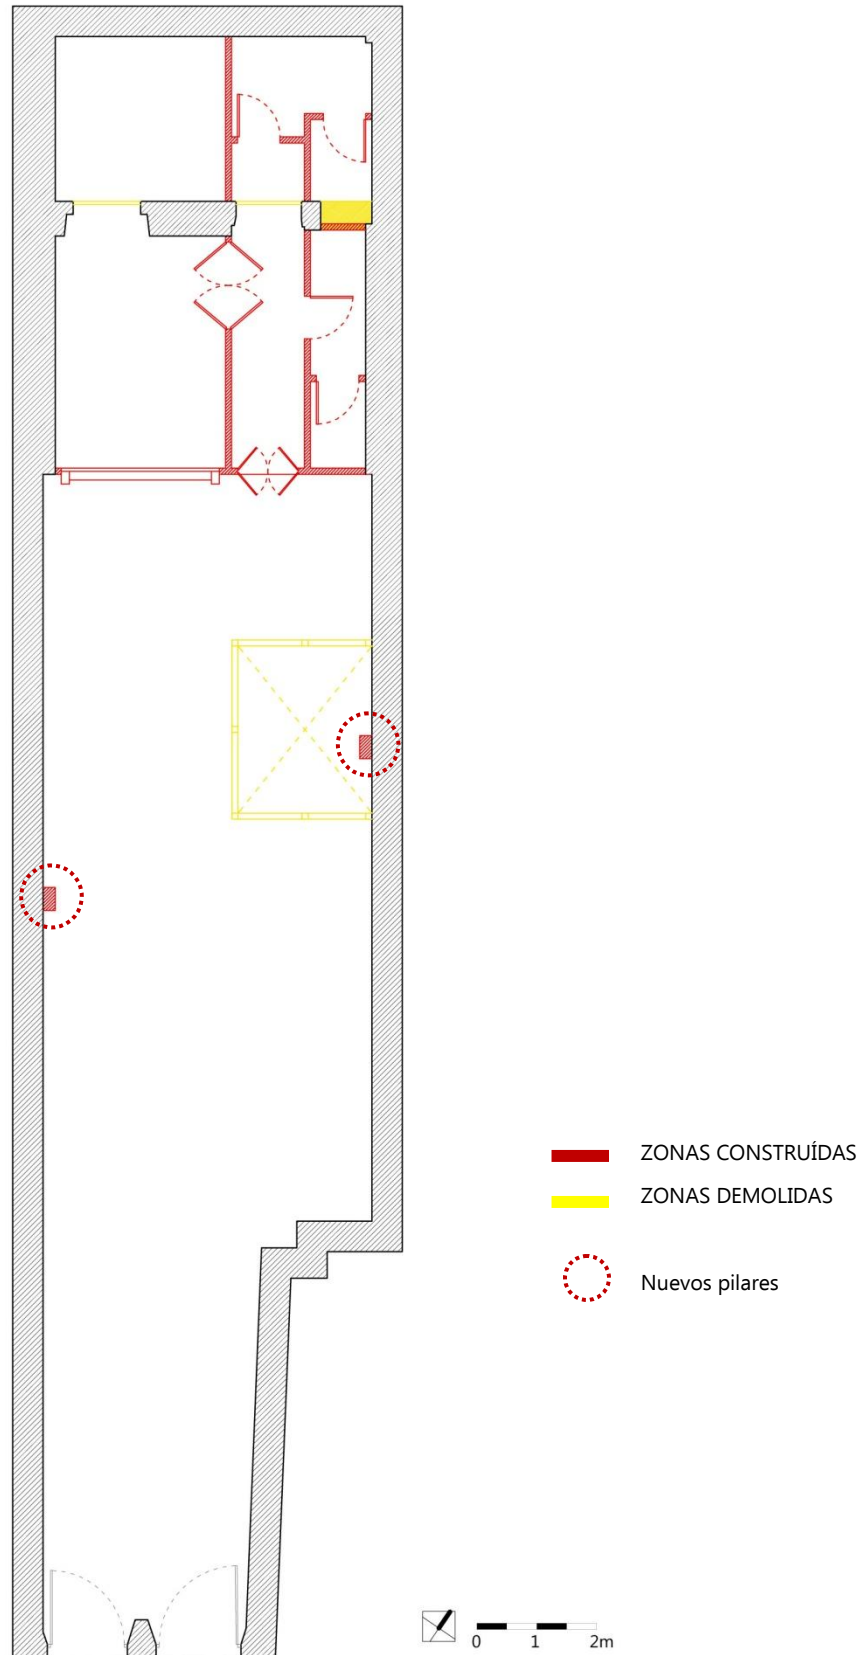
Comparación entre la planta de la antigua fábrica de caramelos y la planta de estado actual (FUENTE: Expediente de obra de 1901, AHMC y Proyecto de ejecución de 2007, DUC - Elaboración propia).
